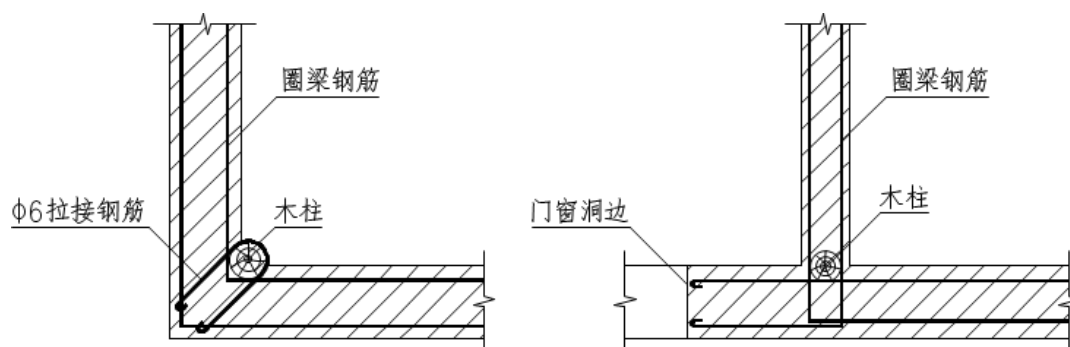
配筋砖圈梁、配筋砂浆带与木柱的拉结
